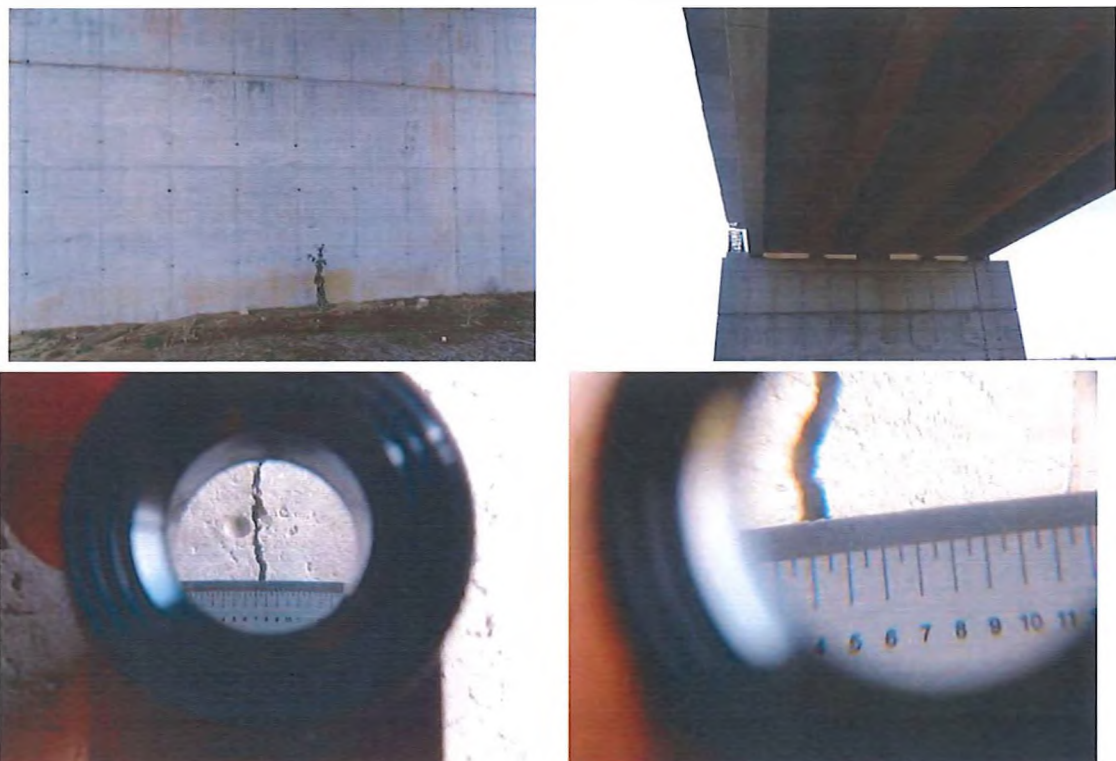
Vederi elevații - fisuri verticale de contracție (până la 0.6mm)
